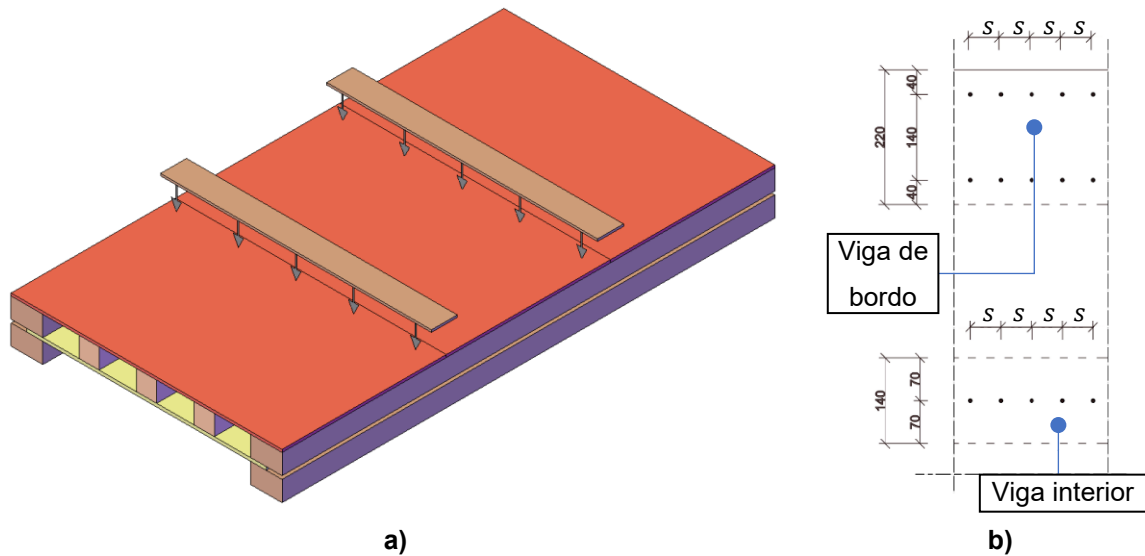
a) Esquema da colocação de pranchas para solidarização de juntas no reforço. b) Esquema de ligações (Dimensões em mm).
